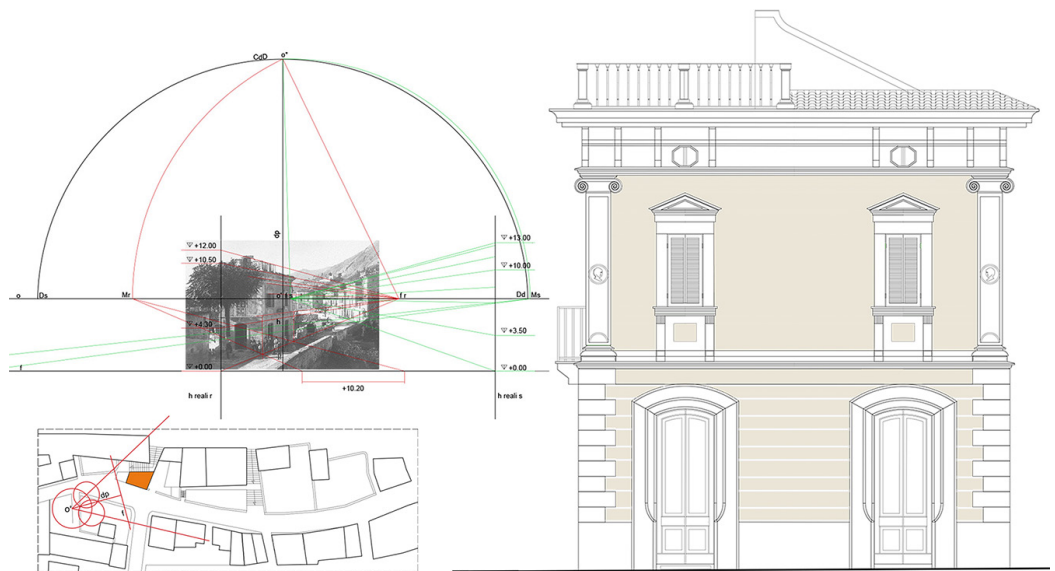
Dalla restituzione prospettica alla rappresentazione bidimensionale.
